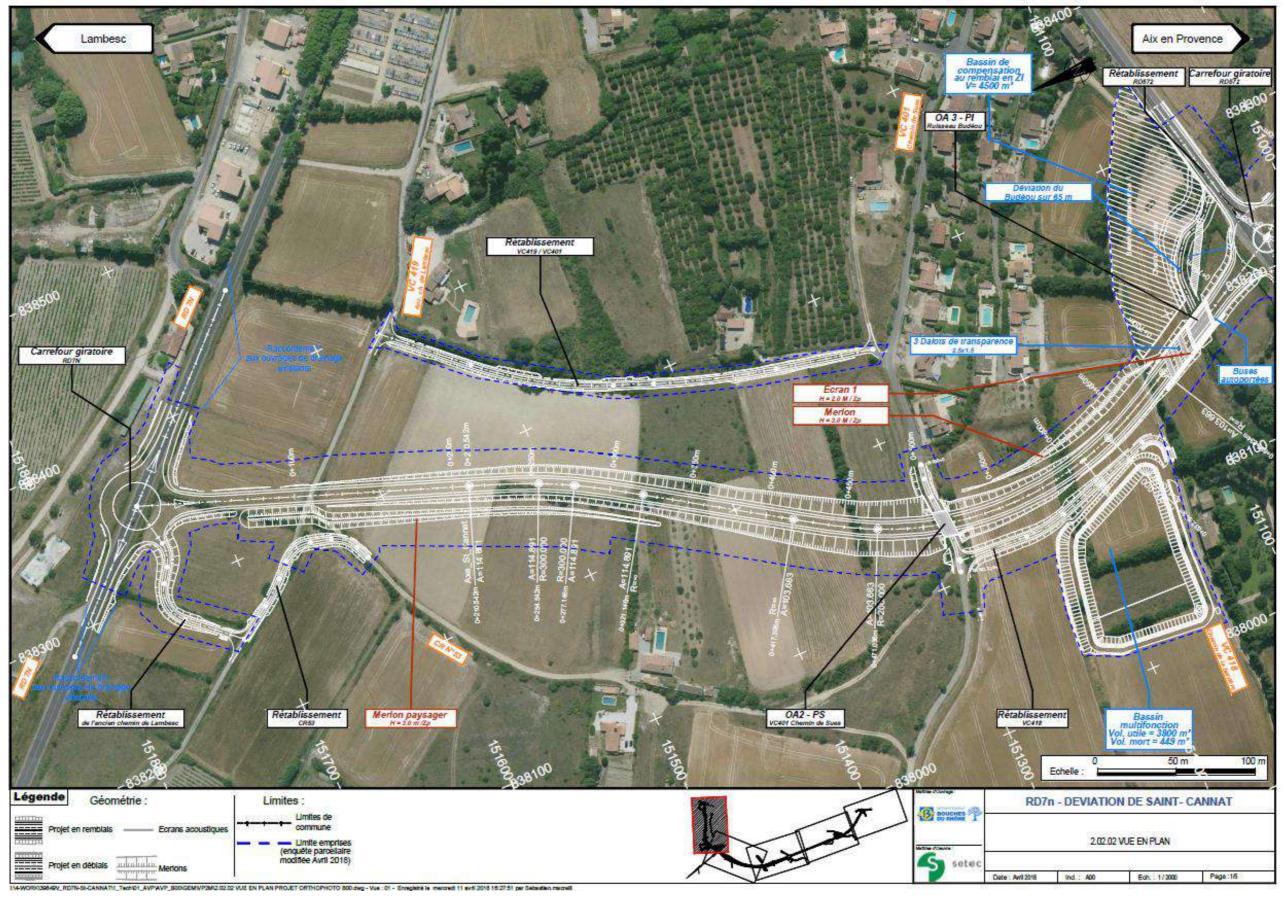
Vue en plan du tracé (planche 1/5) ; source : SETEC
